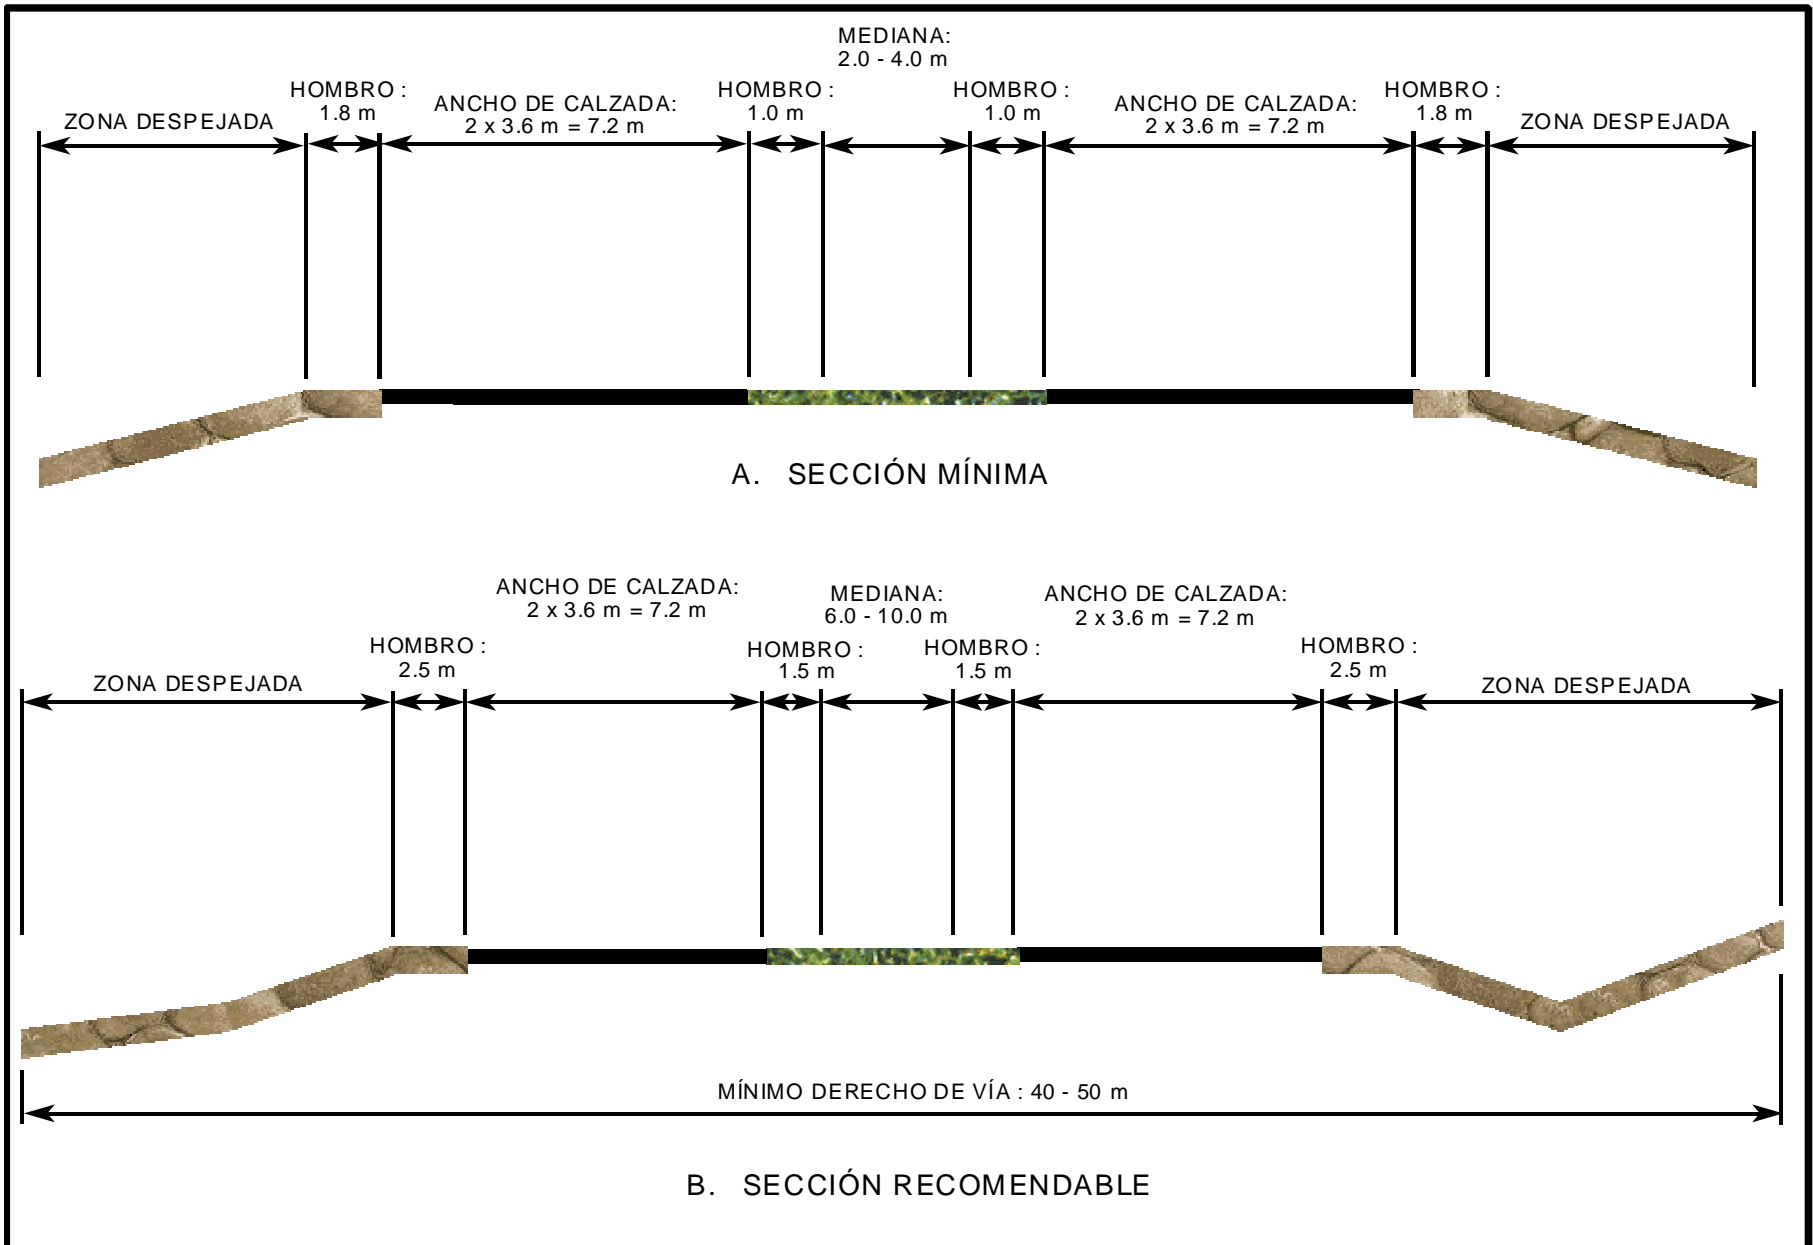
DERECHO DE VÍA Y SECCIONES TRANSVERSALES TÍPICAS DE UNA CARRETERA TRONCAL
